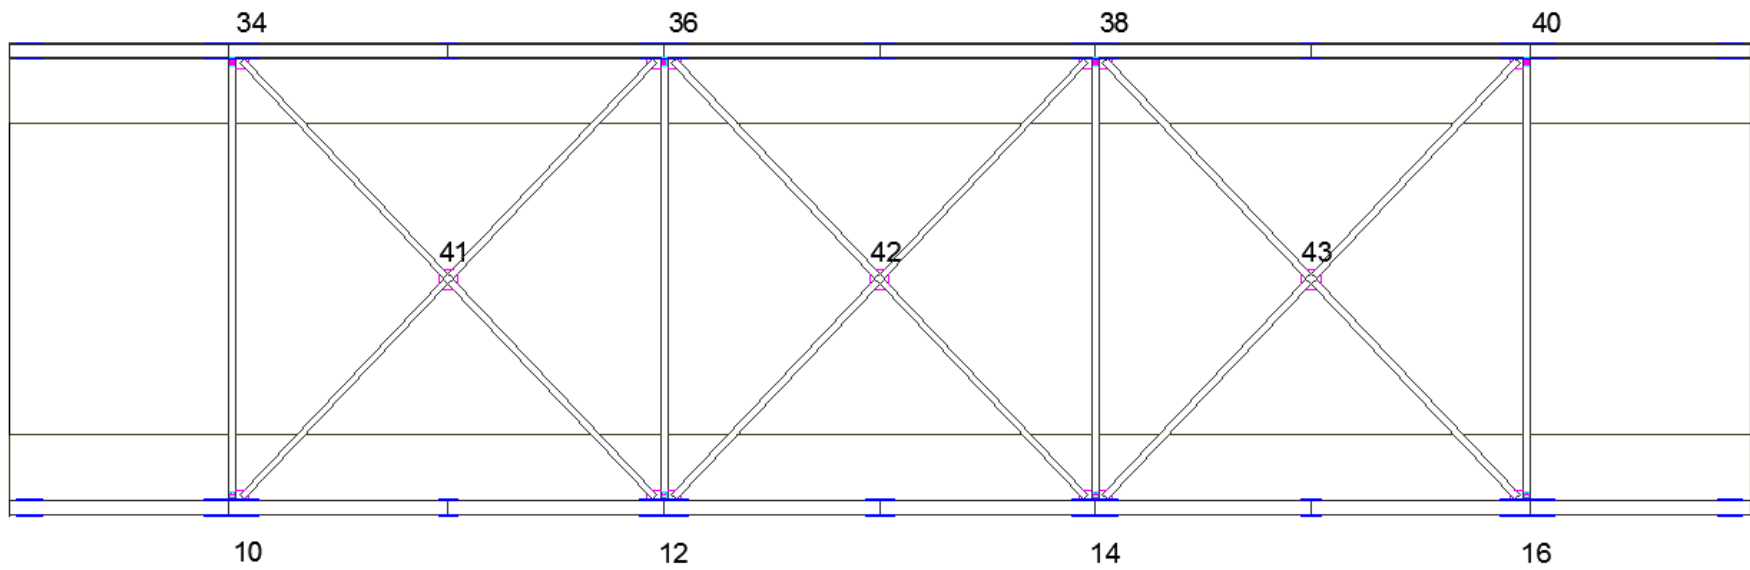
VISTA EN PLANTA DE LA ARMADURA SUPERIOR
